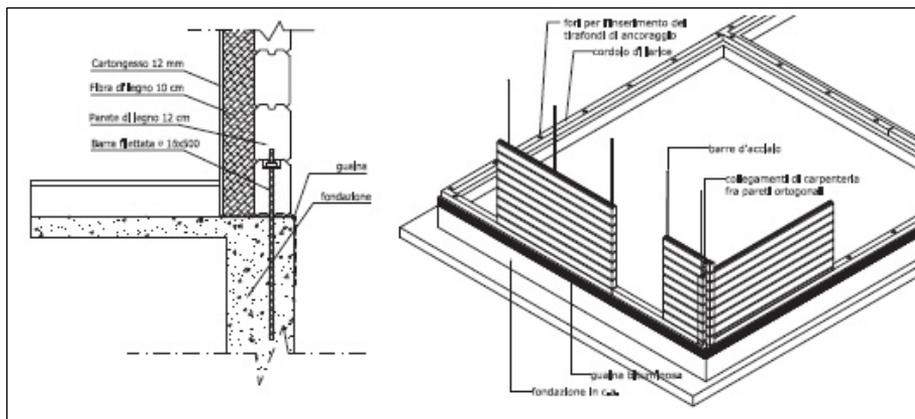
Particolare del collegamento alla struttura di fondazione.
